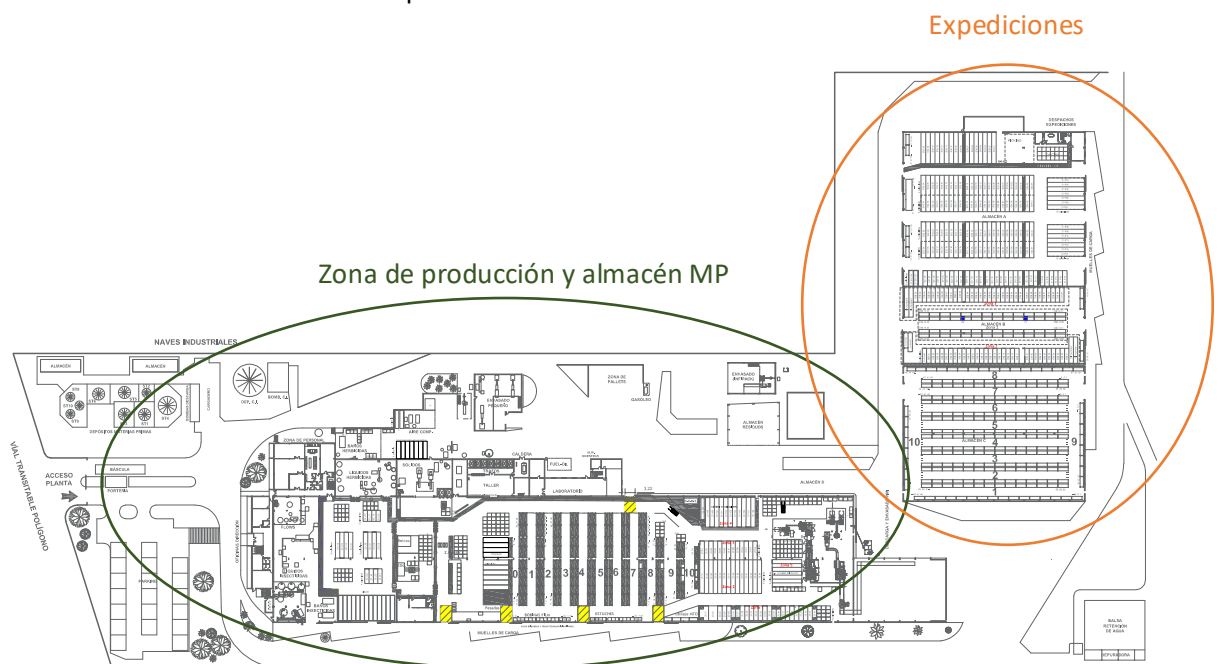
Layout planta Cheste. Fuente: propia empresa.
